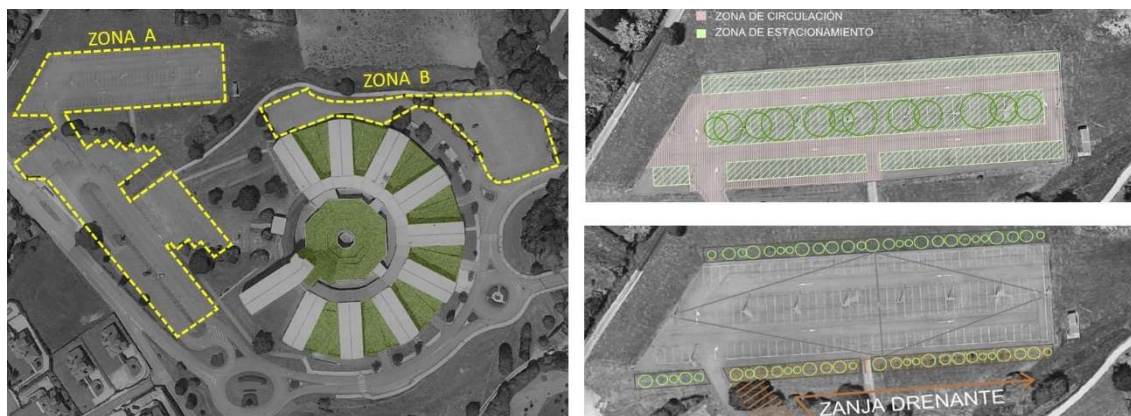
Propuesta de cubiertas vegetales en la EPI Gijón, y pavimentos permeables y zanjas drenantes en zonas A y B.
